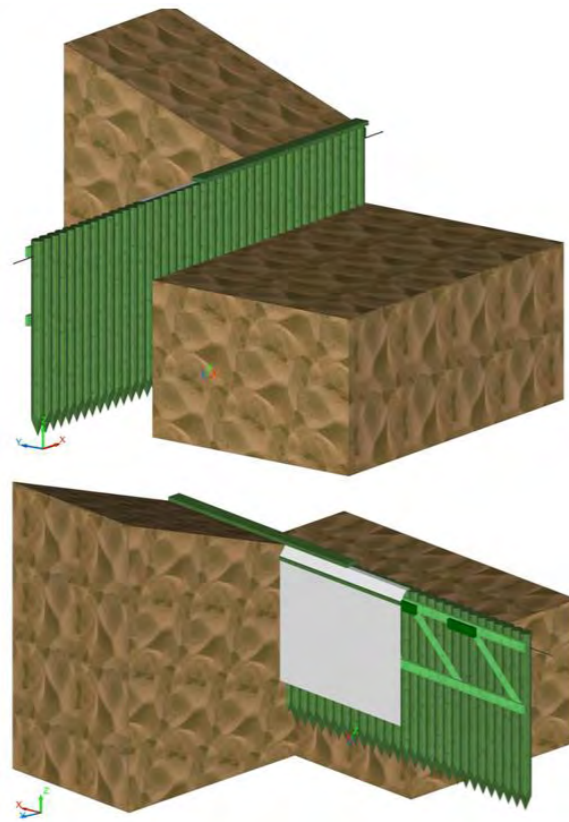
Detalle de la ubicación en el perfil de playa de los pilotes de madera de la empalizada de encauzamiento del arroyo. Fuente: MITECO.
